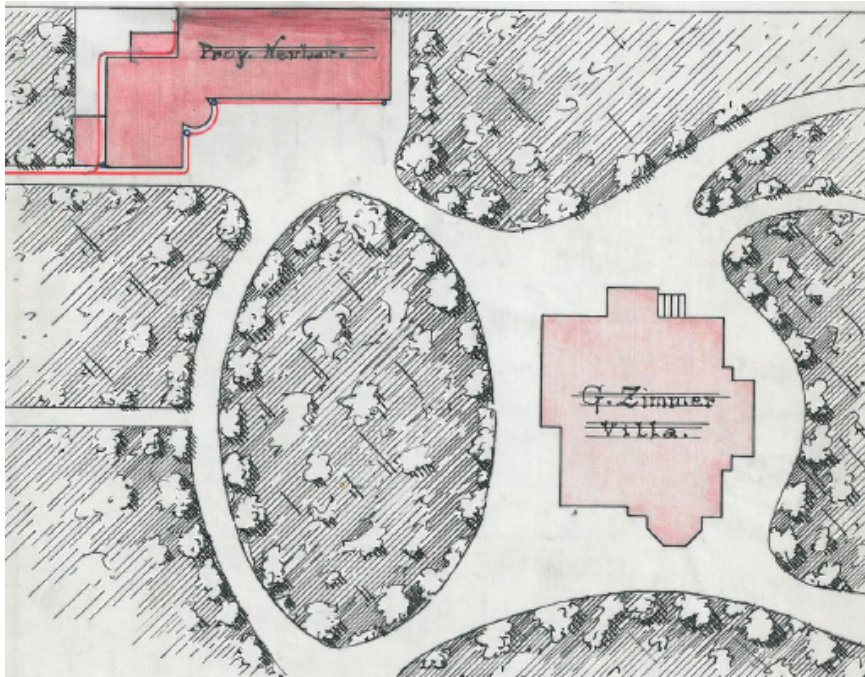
Lageplan von 1891 - damals Handschuhsheimer Landstraße 23 - Quelle Stadt Heidelberg
